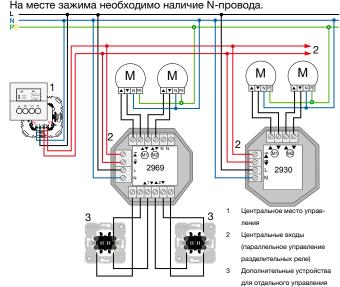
Схема подключения разделительного реле для наружного и скрытого монтажа
